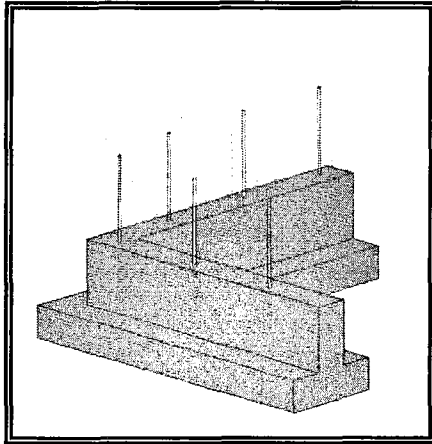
Gazbeton Blokların Birleşim Örnekleri
